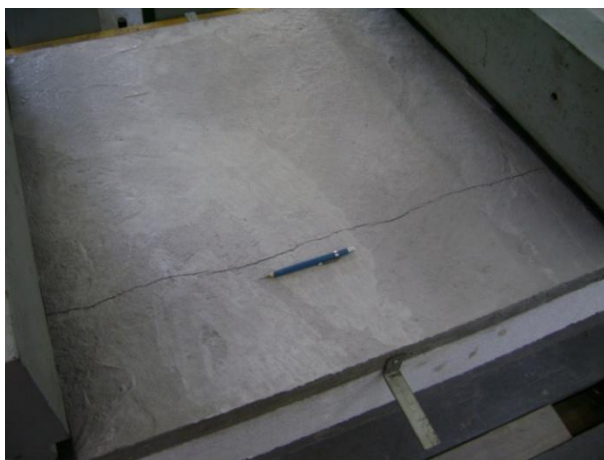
Aparecimento de fissura longitudinal sobre o perfil.
